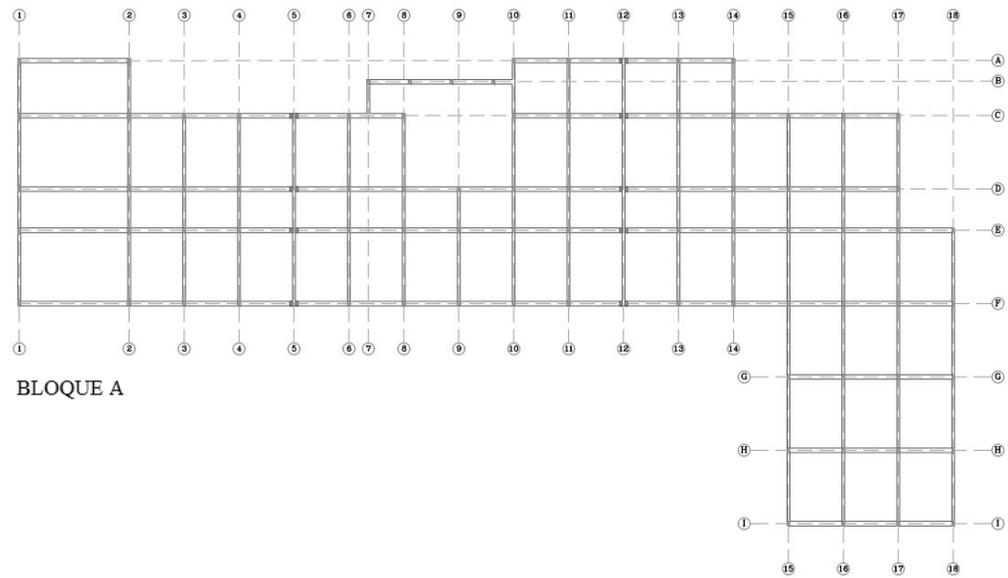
Plano de Cimentación / Fuente: Elaboración propia
